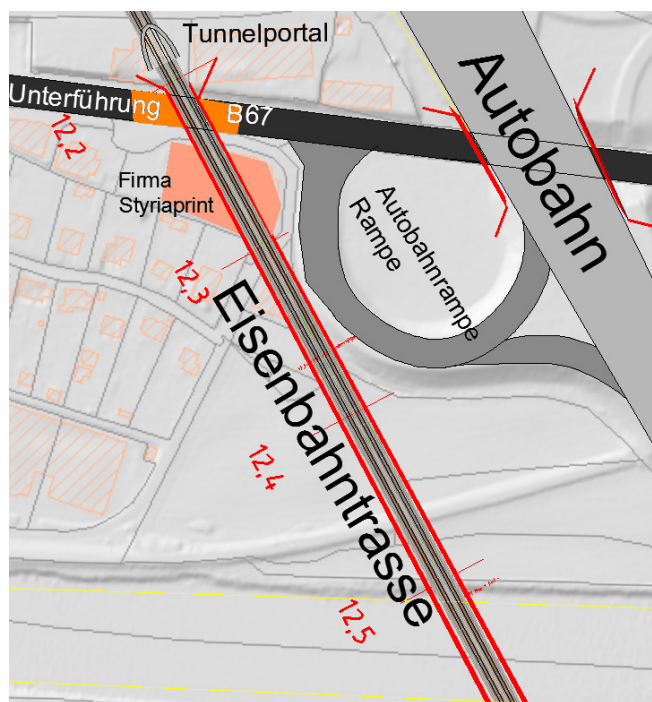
Lageplan Unterführung der B 67 Variante „Gösting“
